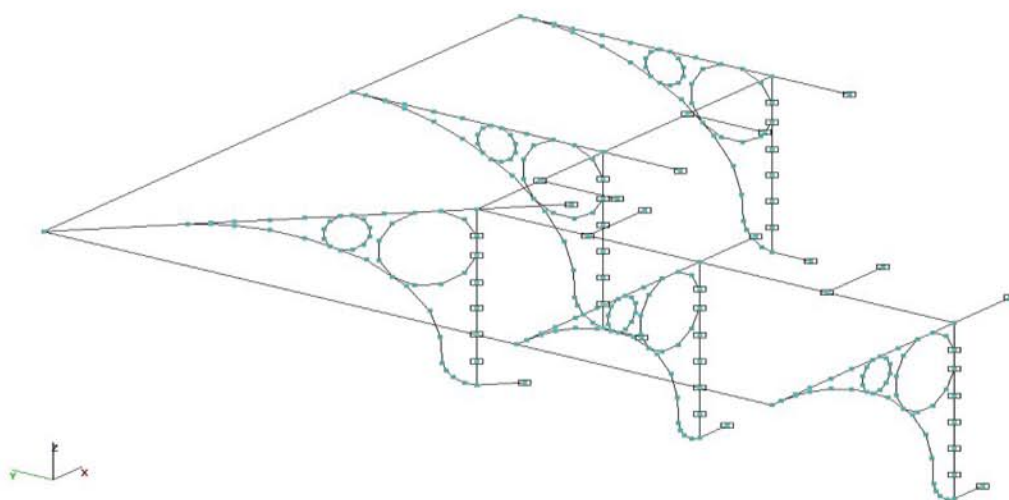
Пространственная стержневая расчетная схема фрагмента углового балкона
